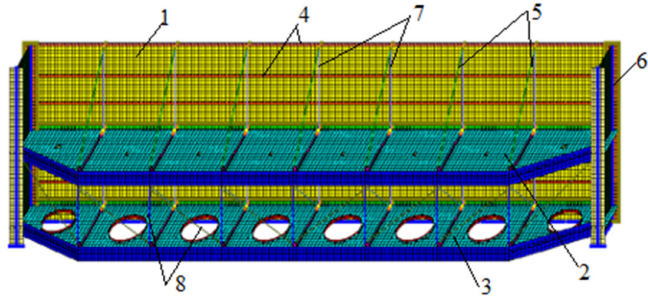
/ Fig 4. Расчетная модель стального плоского затвора: 1 – обшивка; 2 – верхний ригель; 3 – нижний ригель; 4 – вспомогательные балки; 5 – стойки; 6 – опорно-концевые стойки; 7 – верхние раскосы поперечных связевых ферм; 8 – продольная связевая ферма / Calculation model of a steel flat valve: 1 – casing; 2 – upper crossbar; 3 – lower crossbar; 4 – auxiliary beams; 5 – racks; 6 – support-end posts; 7 – upper braces of transverse braced trusses; 8 – longitudinal braced truss
